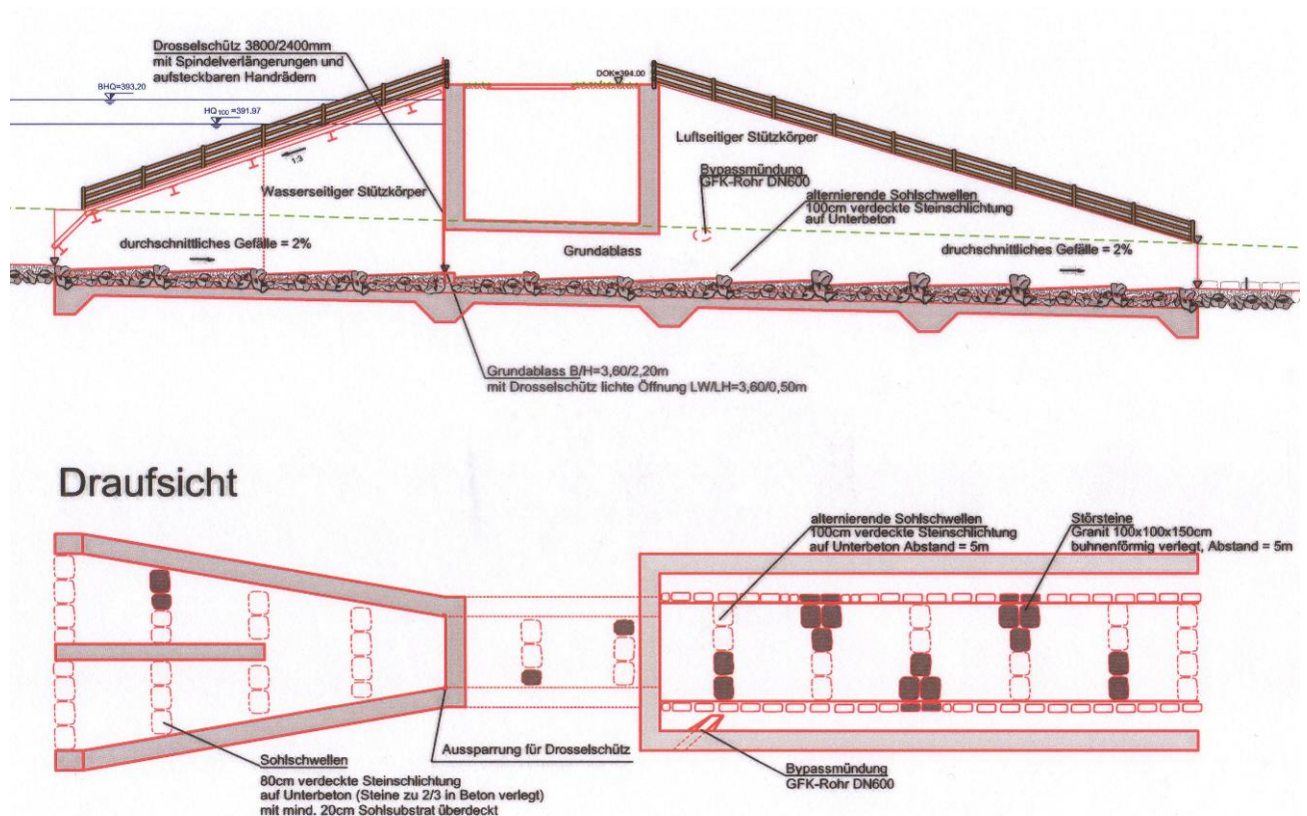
Plan - Grundablass, Sohle mit alternierenden Querriegeln (Perzplan, 2008)
